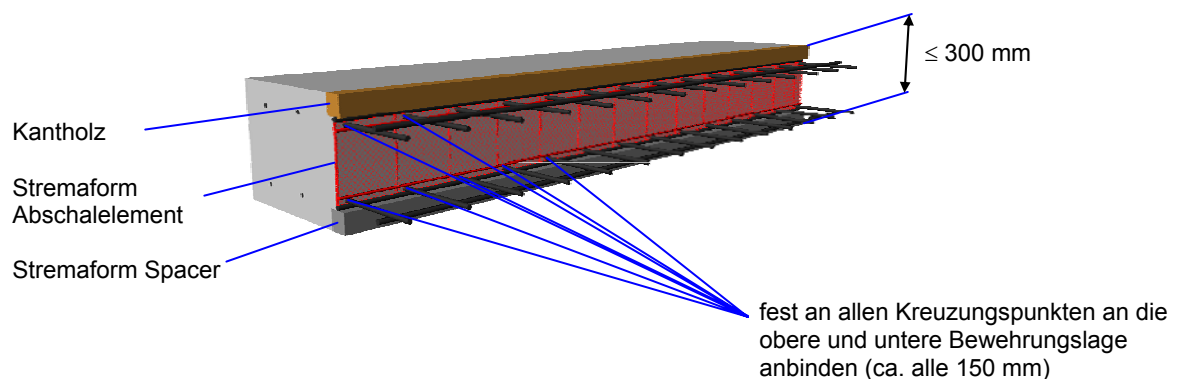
Stremaform Spacer mit dreieckigem Faserbetonabstandhalter
